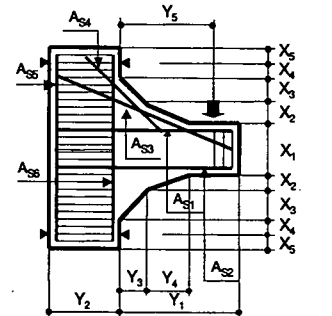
試験体の形状と配筋状況 (TYPE-IV②)
